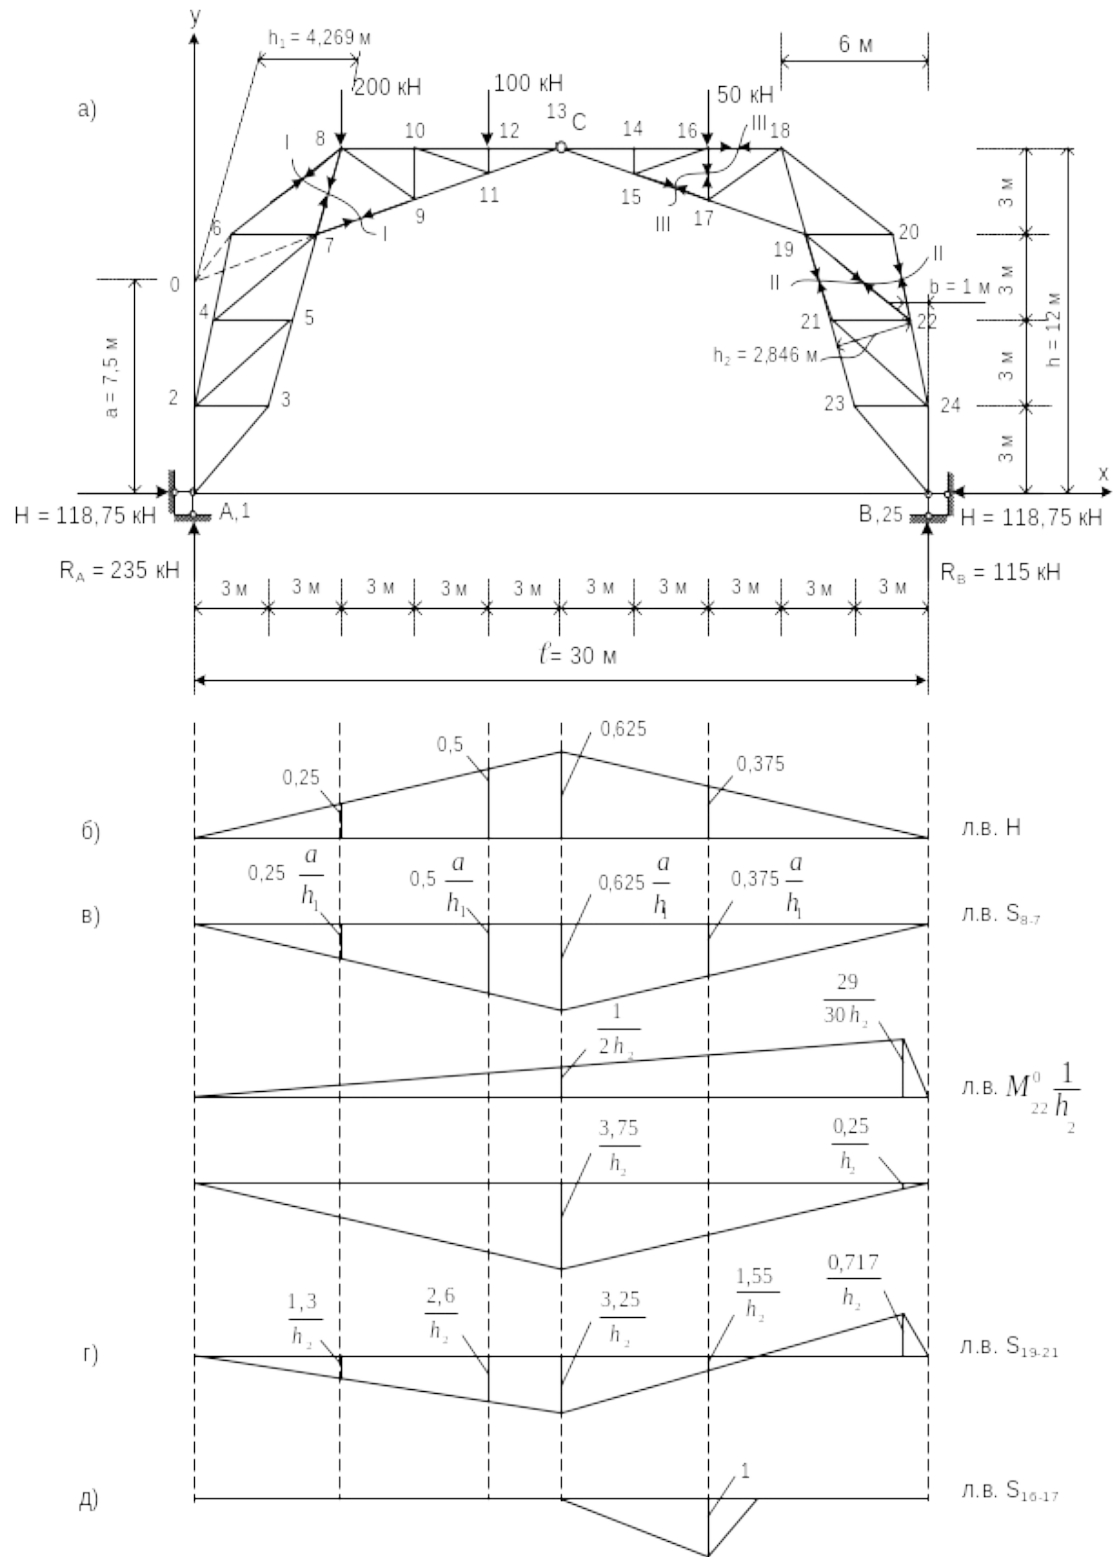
Розрахункова схема аркової ферми і лінії впливу зусиль у стрижнях
